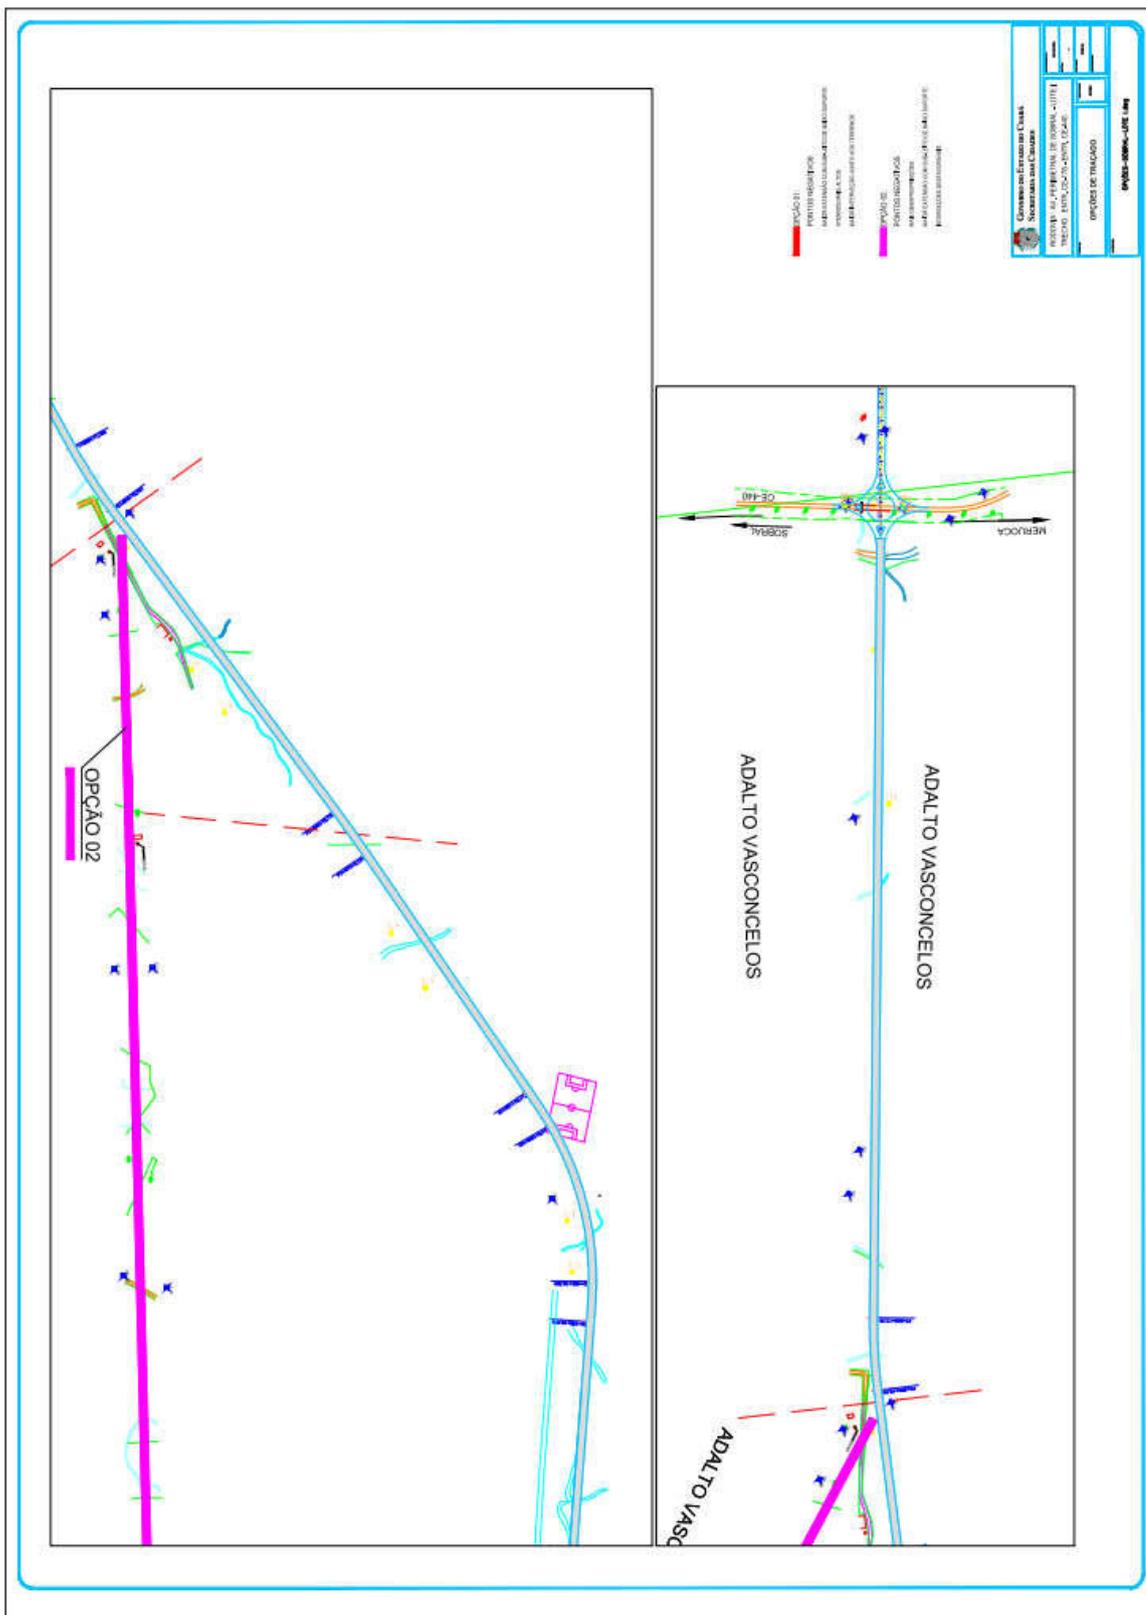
ALTERNATIVAS LOCACIONAIS PARA O EMPREENDIMENTO.
